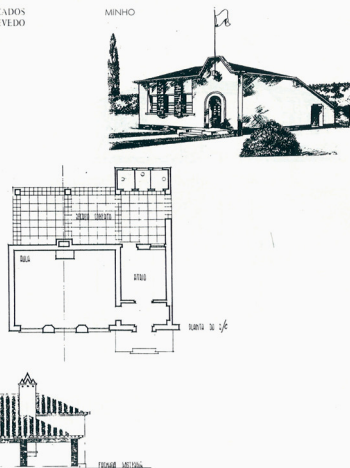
Perspectiva, planta e alçado posterior do edifício Tipo Minho Riposte — 1 sala. (Arquivo DGCE).
